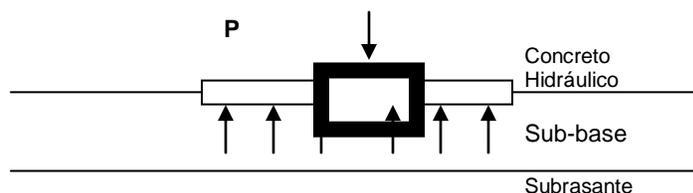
Concreto Hidráulico. Fuente apuntes de Construcción FI.
